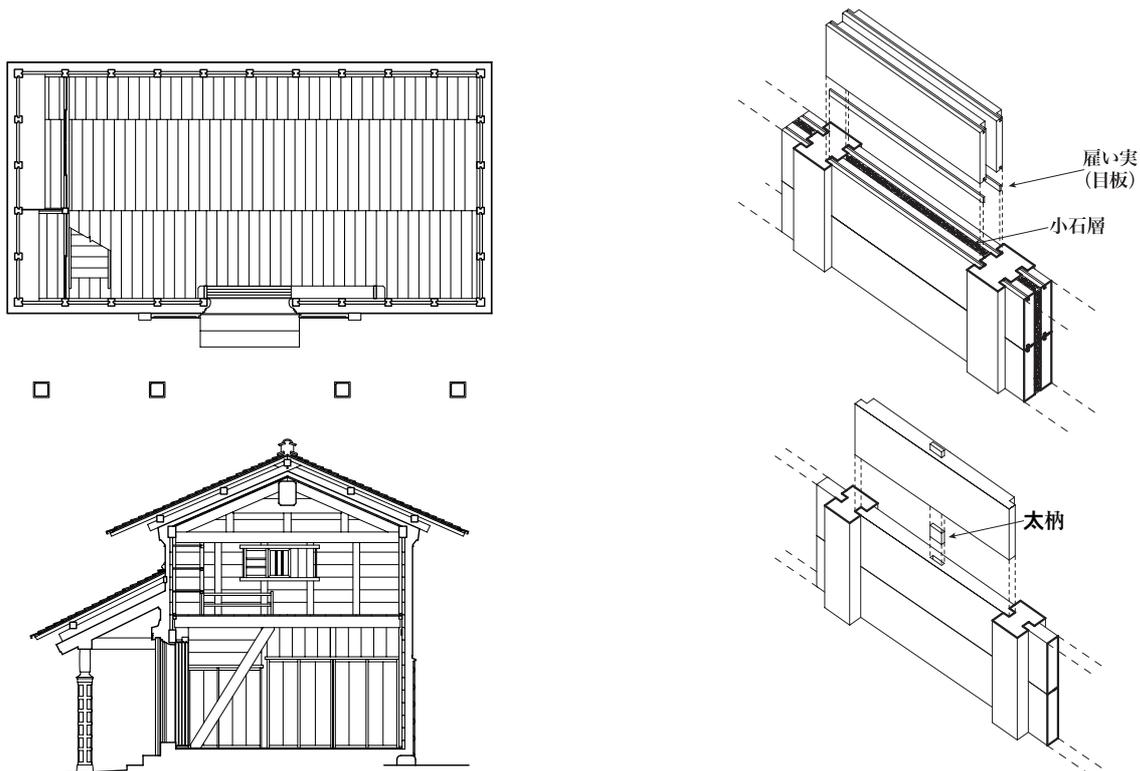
有賀家土蔵 1 : 150 (上 : 1階平面図、下 : 梁行断面図表面筋)
